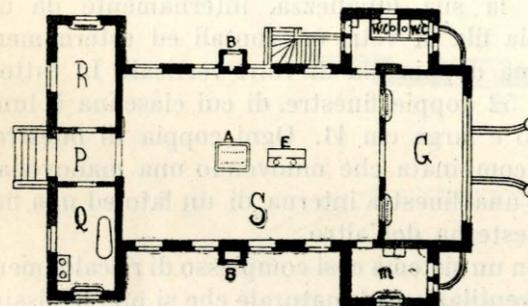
Pianta d'un padiglione d'isolamento per 15 letti.
